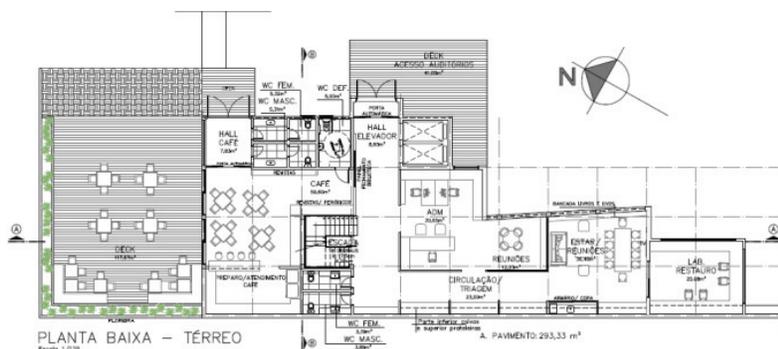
Planta Baixa Térreo - Fonte: Triple Arquitetura, 2013.
